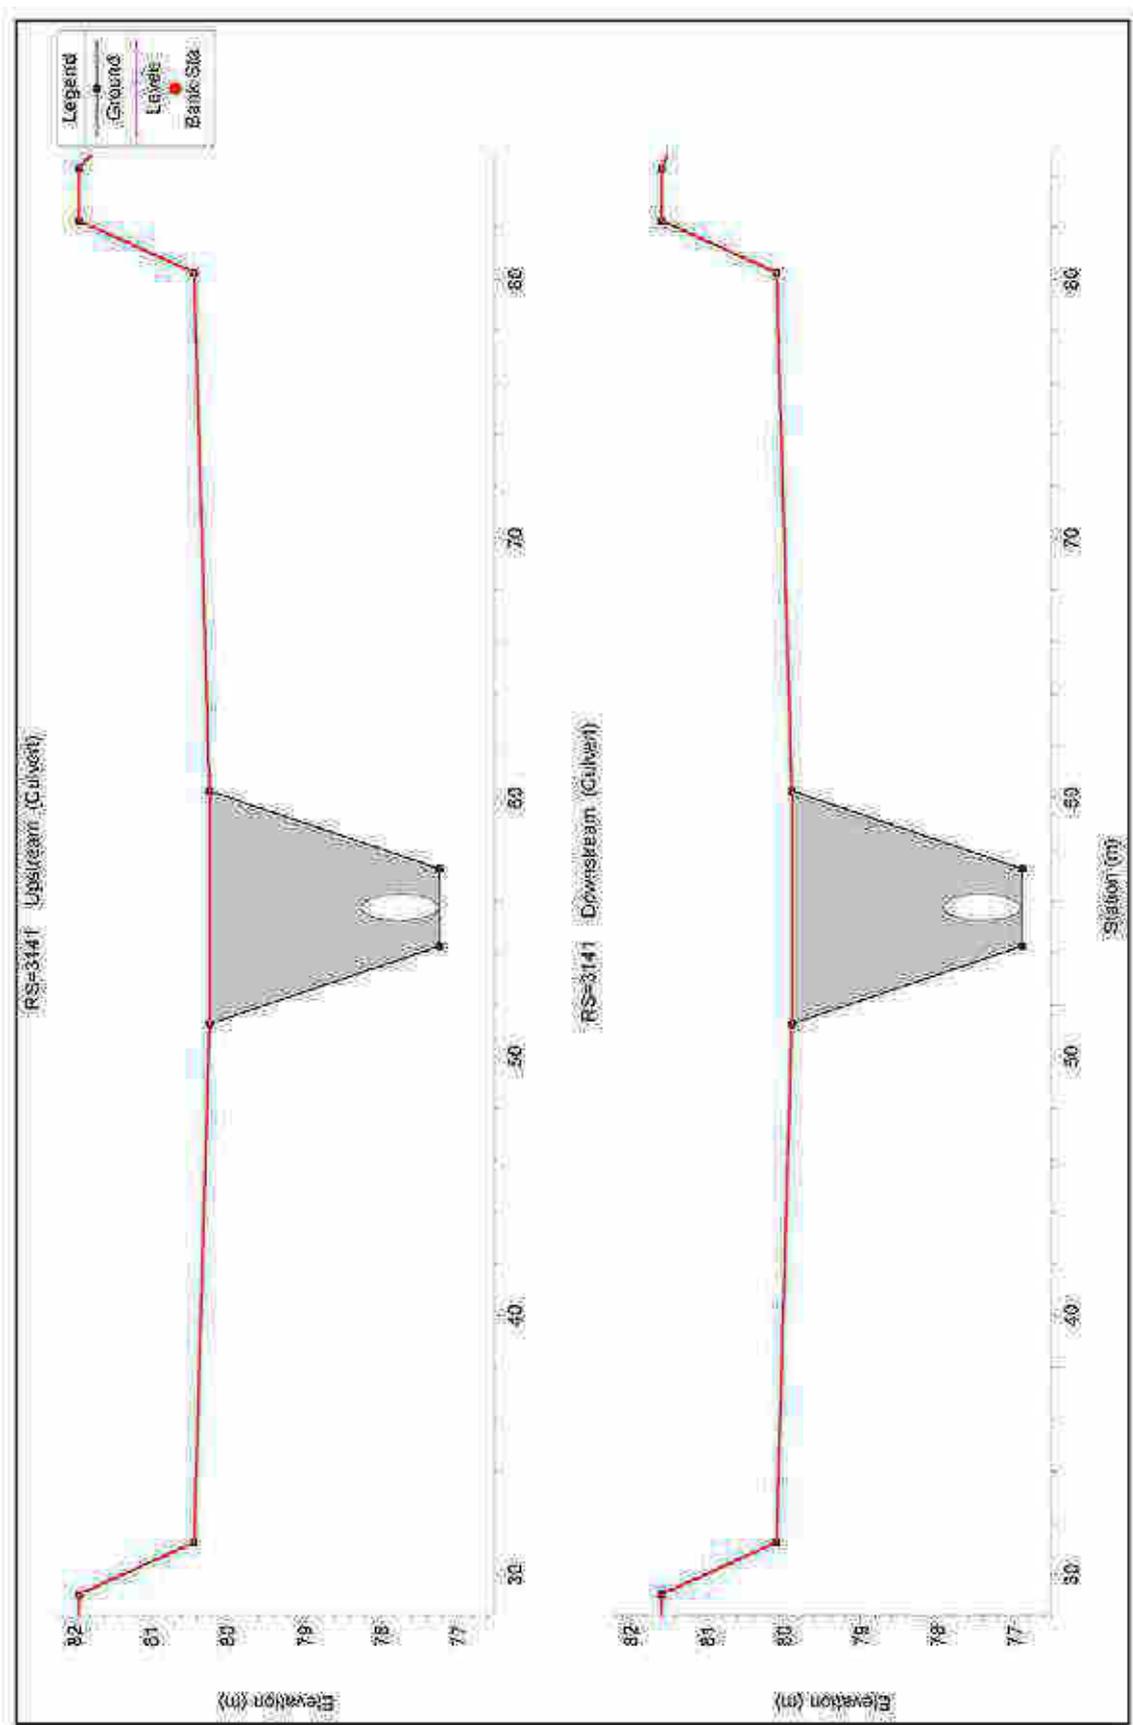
Modellazione in HEC-RAS del canale tombato RS = 3141: Upstream (Sezione a monte) – Downstream (Sezione a valle)
